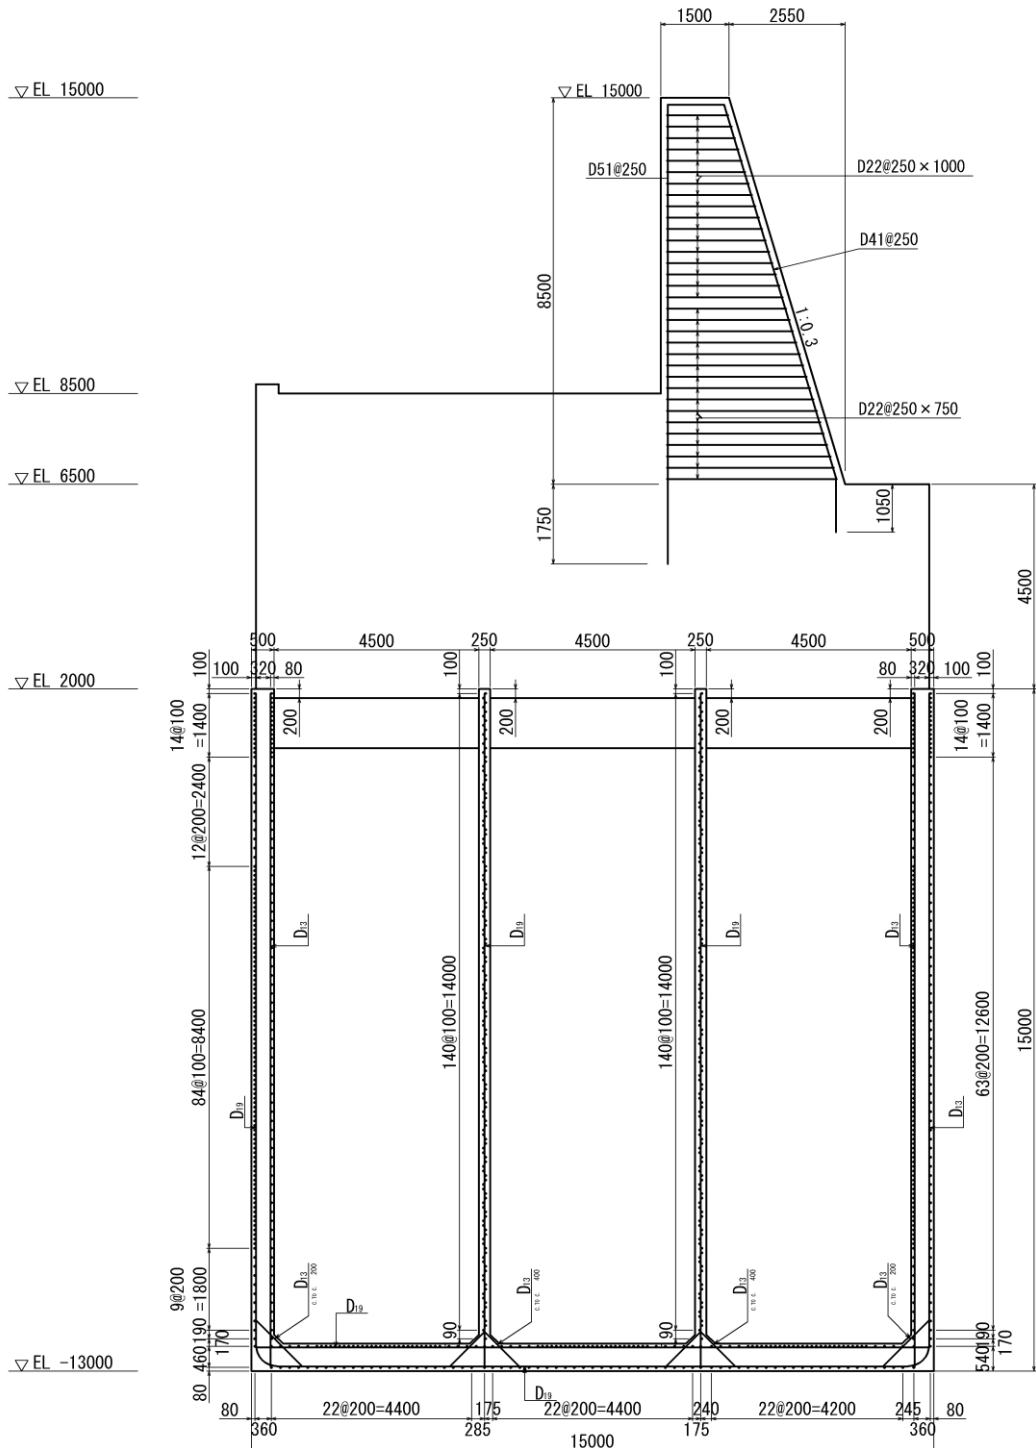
(4) 防波壁（波返重力擁壁）の重力擁壁及びケーソンの概略配筋図
